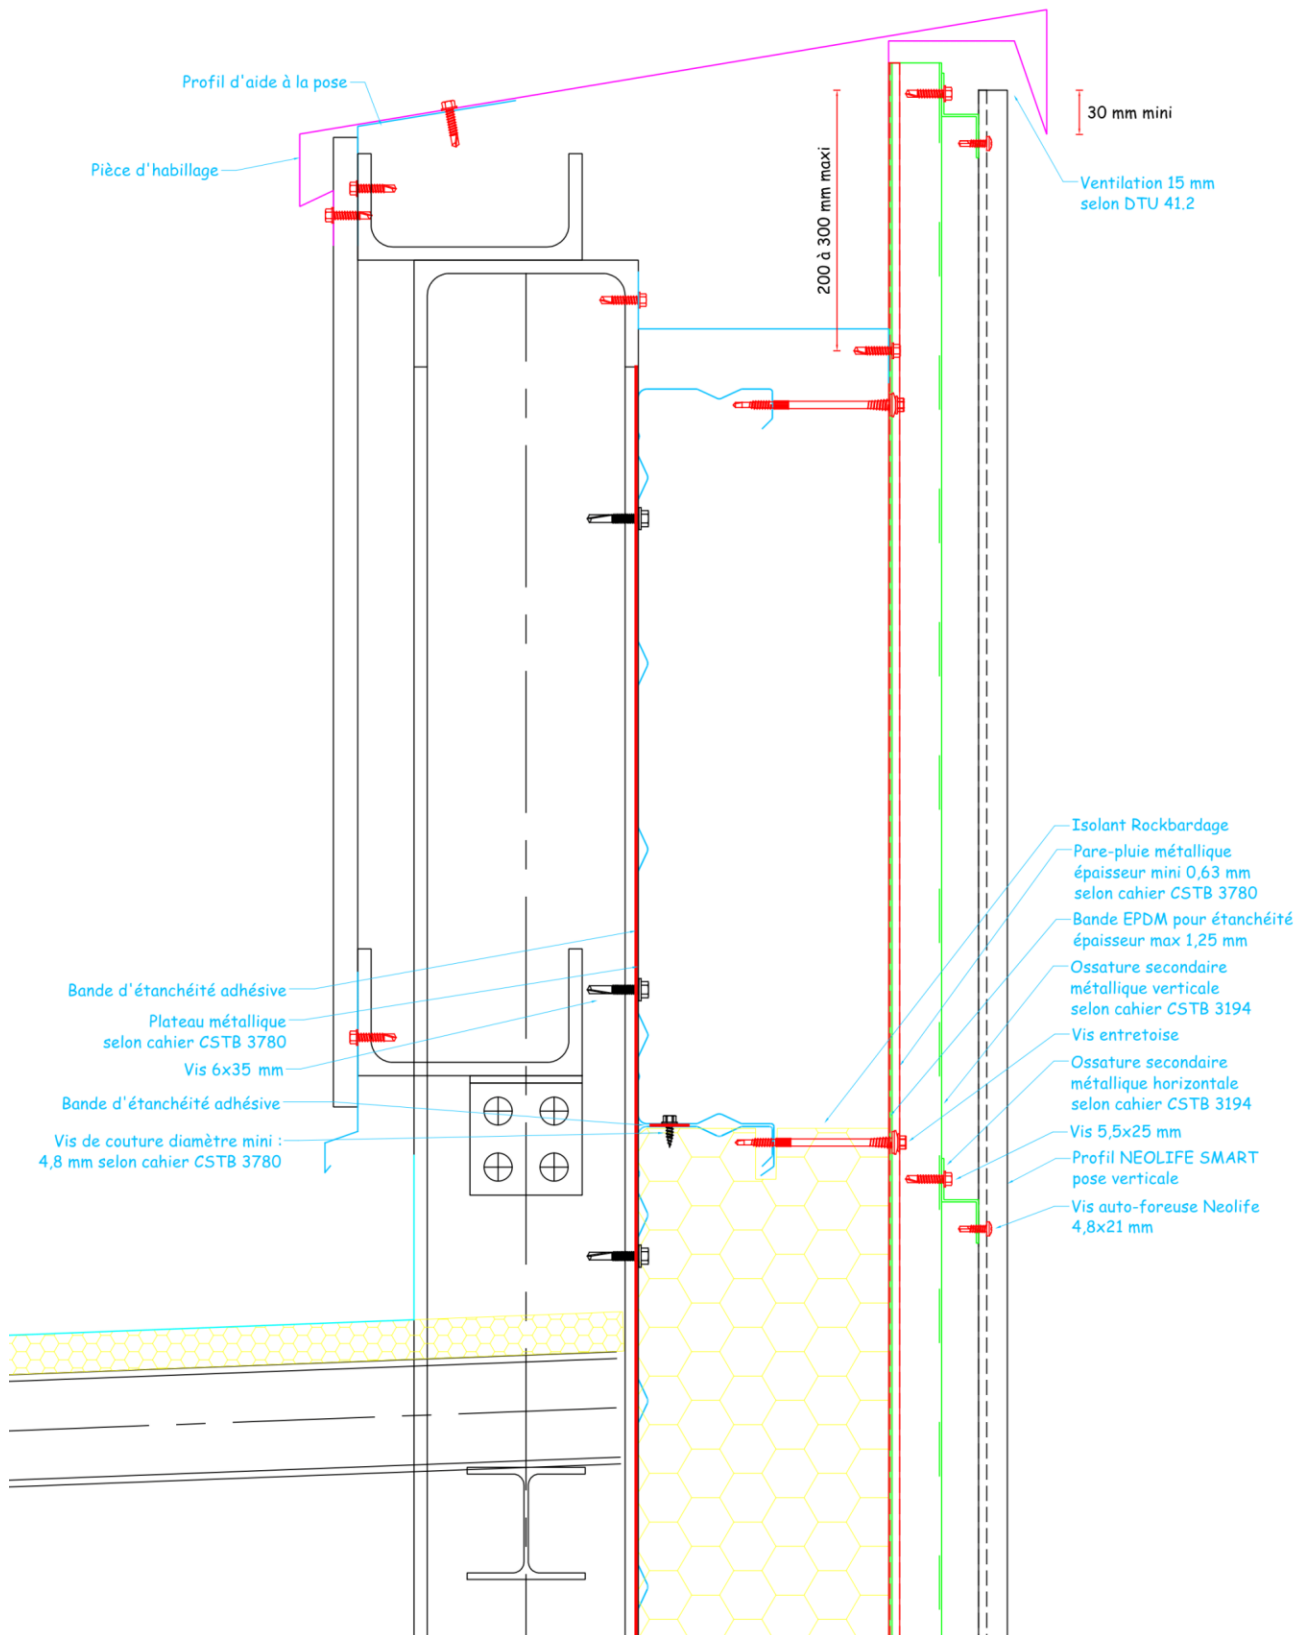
Arrêt sur acrotère (coupe verticale 1)
